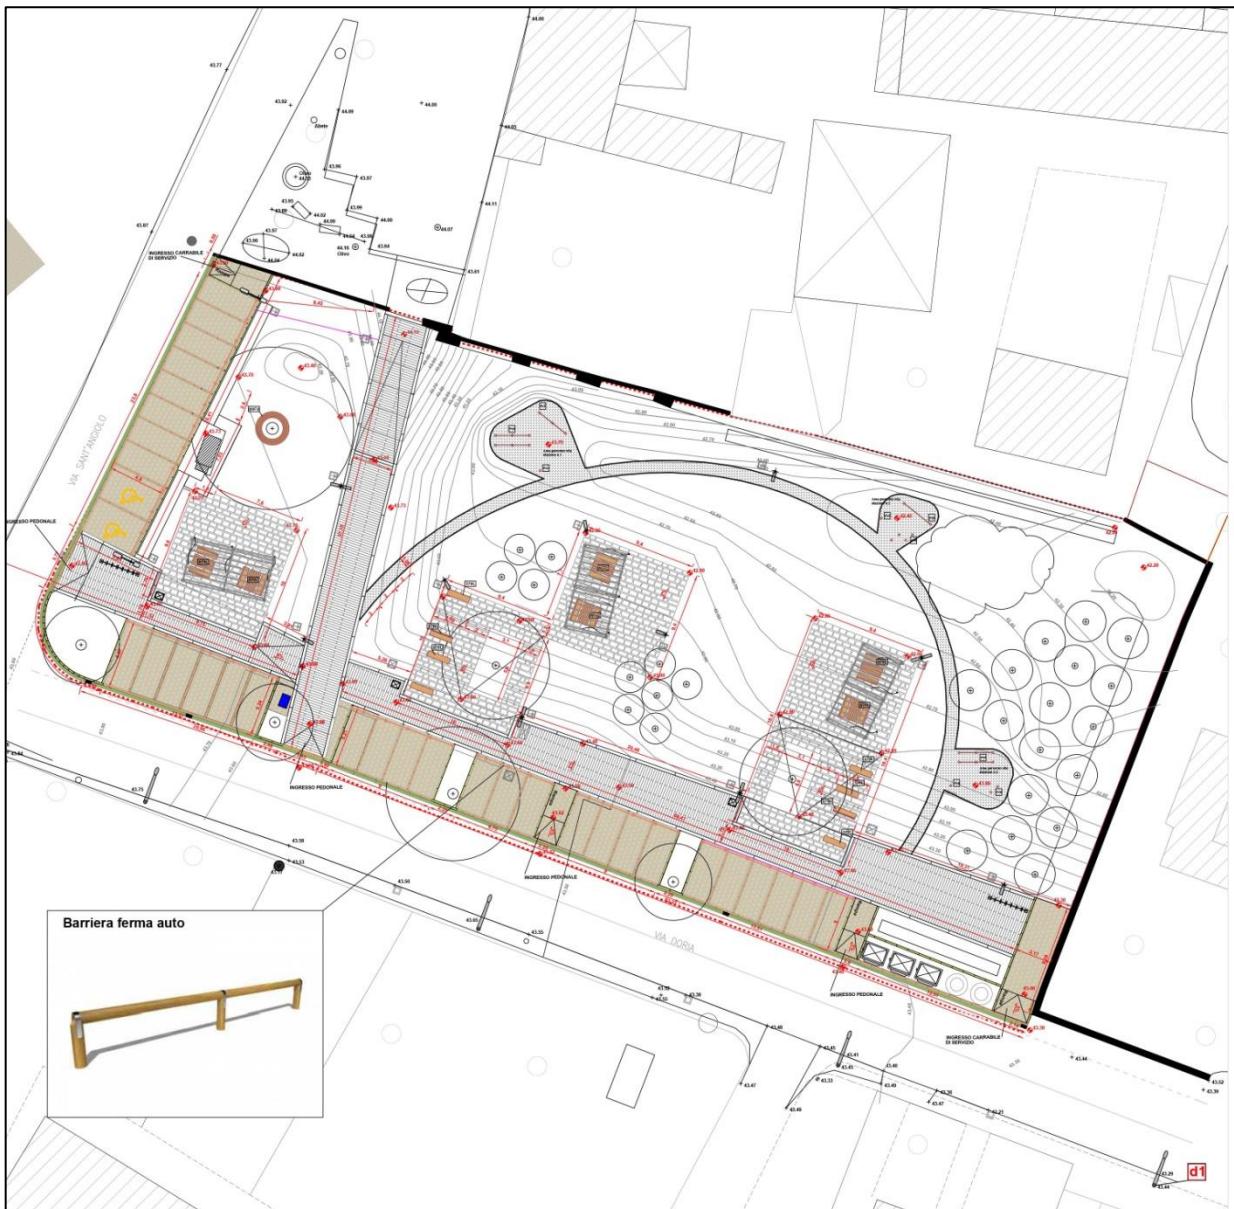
Estratto planimetria di progetto Piazza su via Sant'Angiolo e via A. Doria
